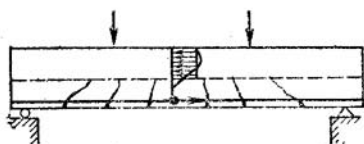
Напряженное состояние бетона сжатой зоны при изгибе железобетонной балки
